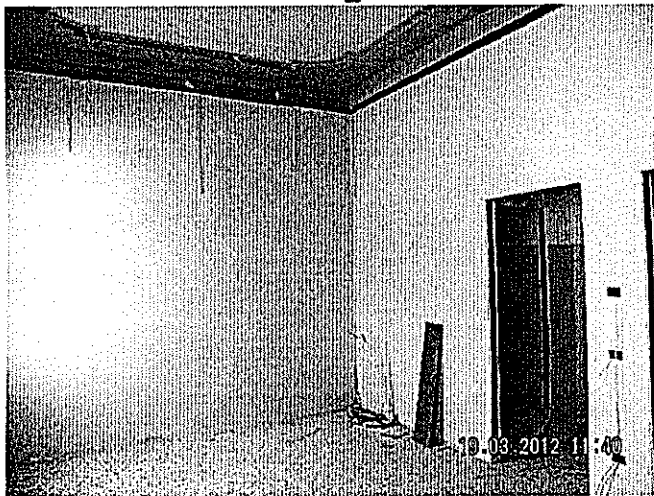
Stanza 1.1: Vista porta ingresso bagno (stanza\_1.2)
